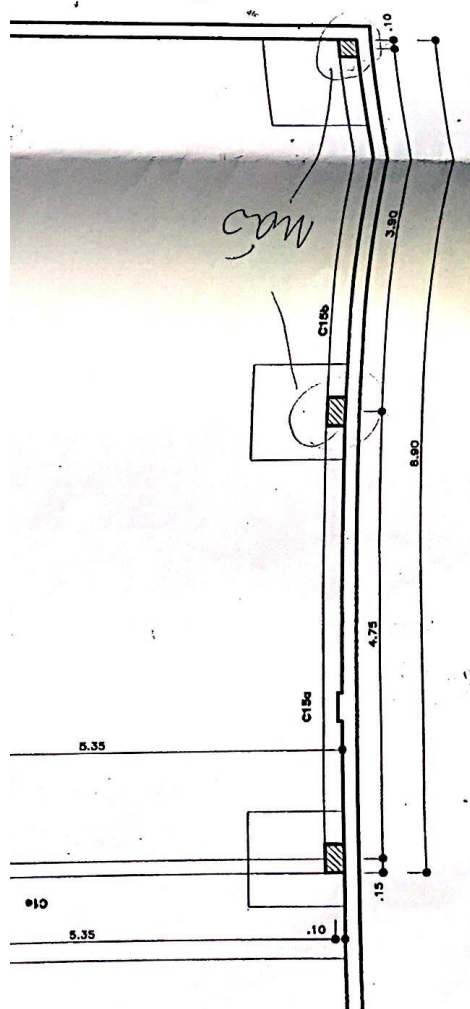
Det. Ampliado do projeto Estrutural – Sapata de Borda – Planta baixa
